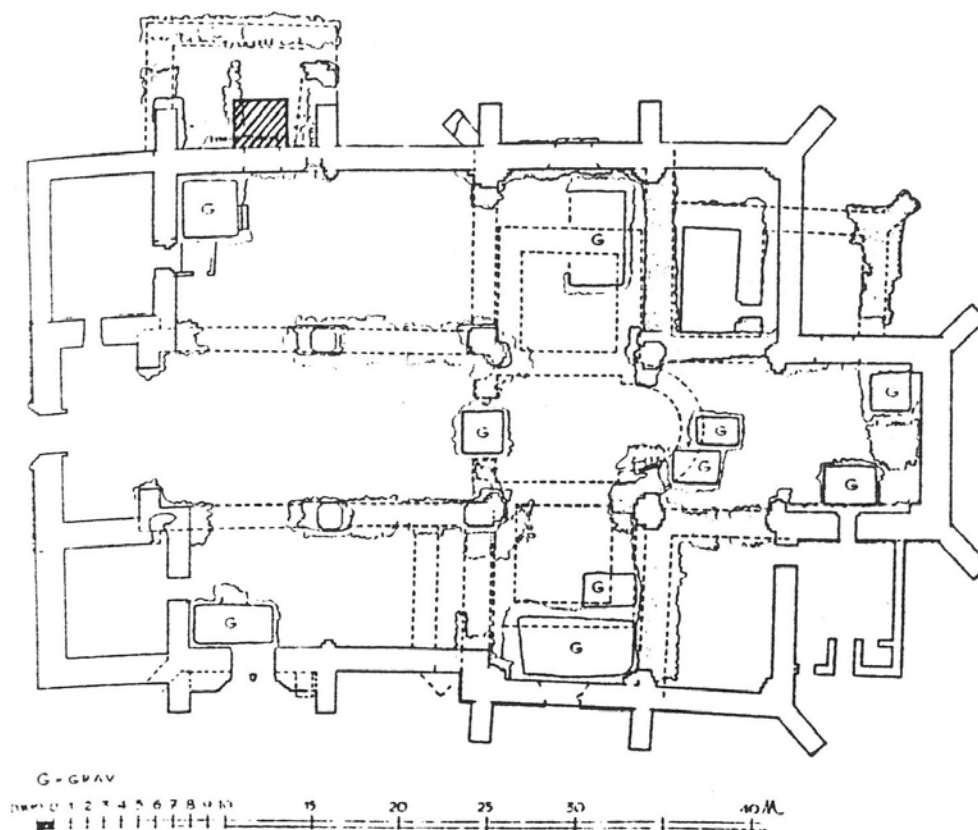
Plan över domkyrkan med grundmurar, gravar och murrester markerade. I nordväst syns grundmurarna till det norra vapenhuset. Från Gustafsson & Ullén 1970.
